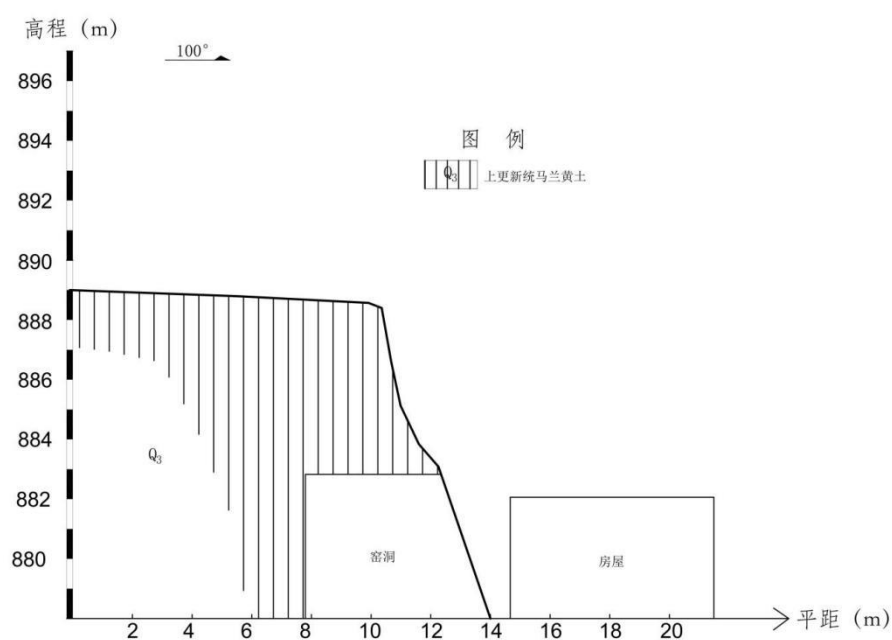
不稳定斜坡 BW04 剖面示意图
